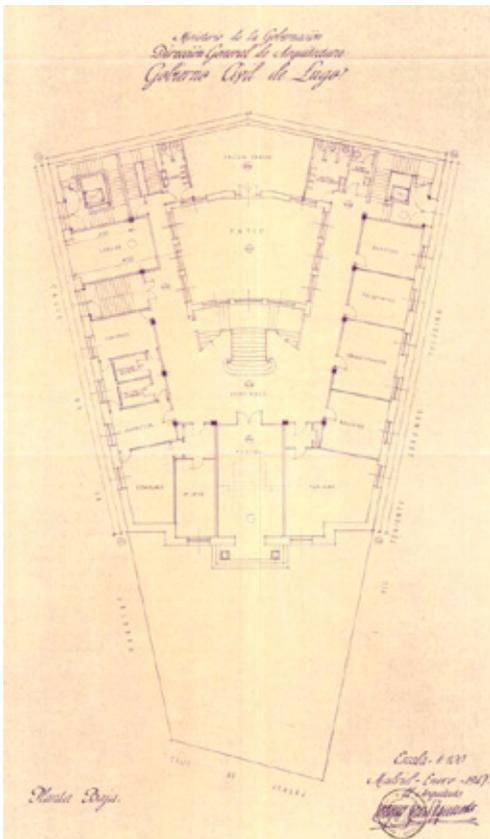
Gobierno Civil de Lugo. Planta baja. Enrique López-Izquierdo Blanco. 1946, marzo. AGA 04 078 26/15893
